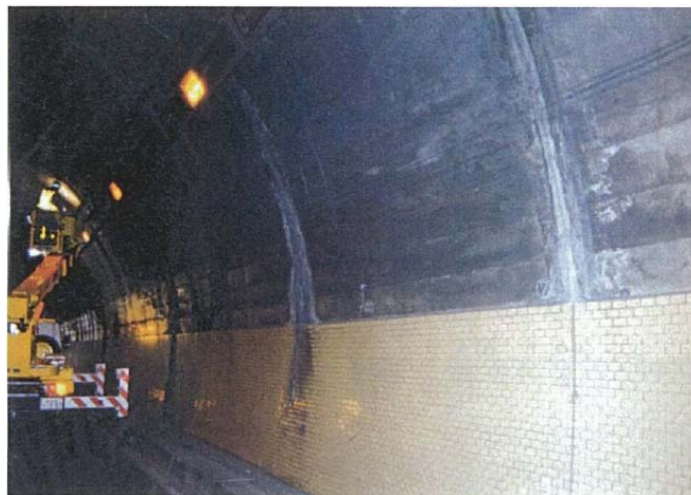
。4 覆工スパンの中間付近に発生したひび割れの例
